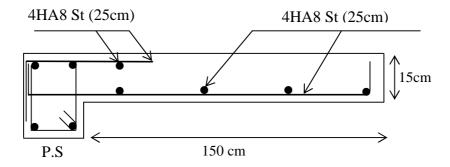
Schéma de ferraillage des dalles pleines internes
